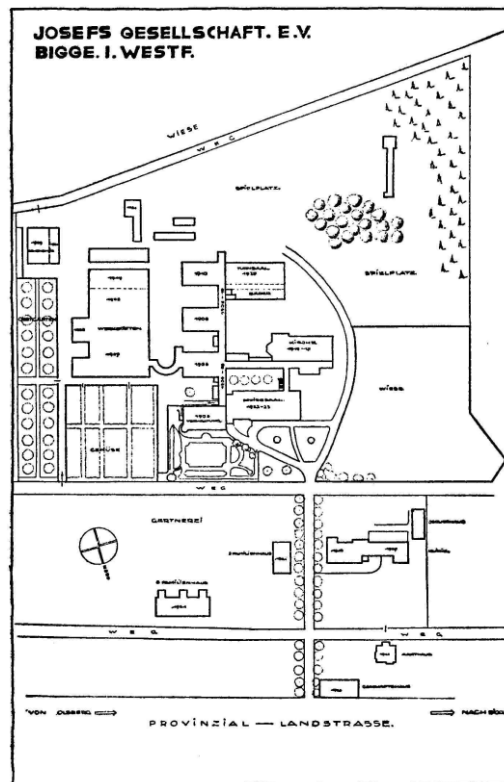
Lageplan der Anstaltsgebäude, 1929
